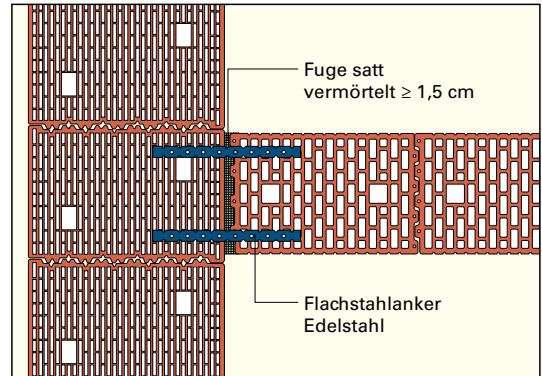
Wände aus Plansteinen mit Stumpfstoßtechnik versetzt
